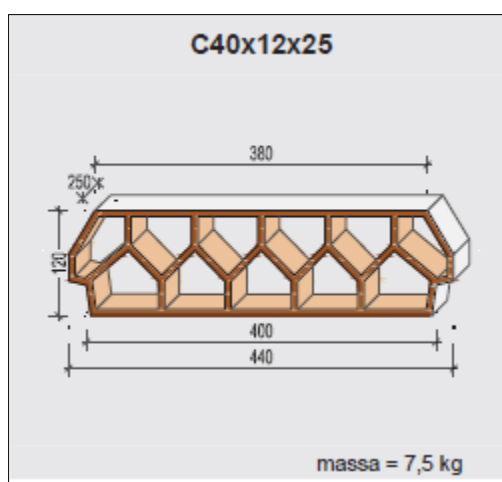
Corte transversal da abobadilha cerâmica (Fonte: LNEC)
